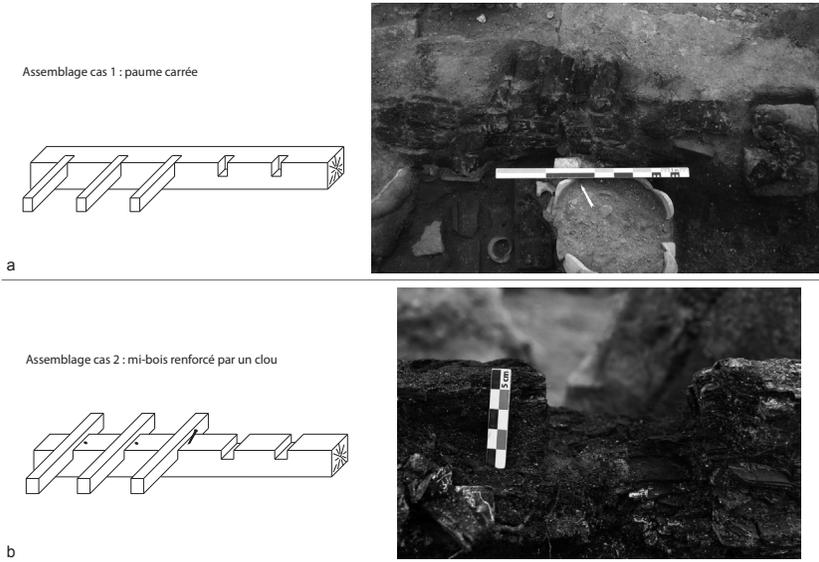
Système d'assemblage de la charpente du complexe A-B : a, assemblage des solives à paume carrée observé au débouché de la cage d'escalier de la boutique A23 ; b, découpe à mi-bois dans une poutre en chêne pour l'installation des solives du plancher au-dessus du portique B2 (clichés : Archeodunum ; DAO : F. Blondel)
